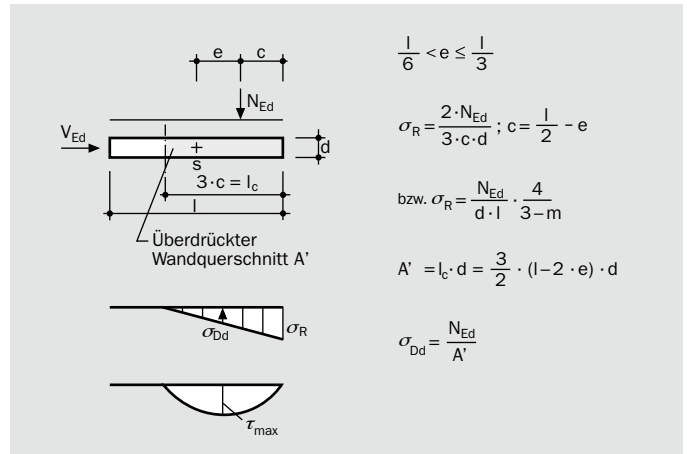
/2: Normal- und Schubspannungen für einen teilweise gerissenen Querschnitt bei Scheibenbeanspruchung
